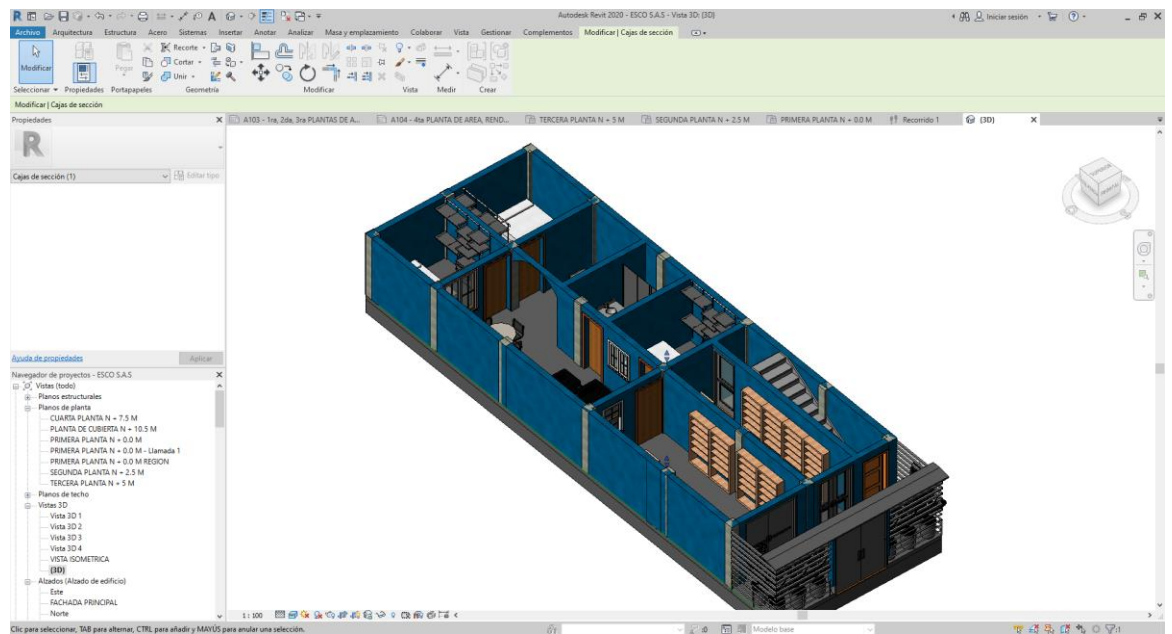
Corte de la primera planta. Revit. Fuente elaboración propia.
